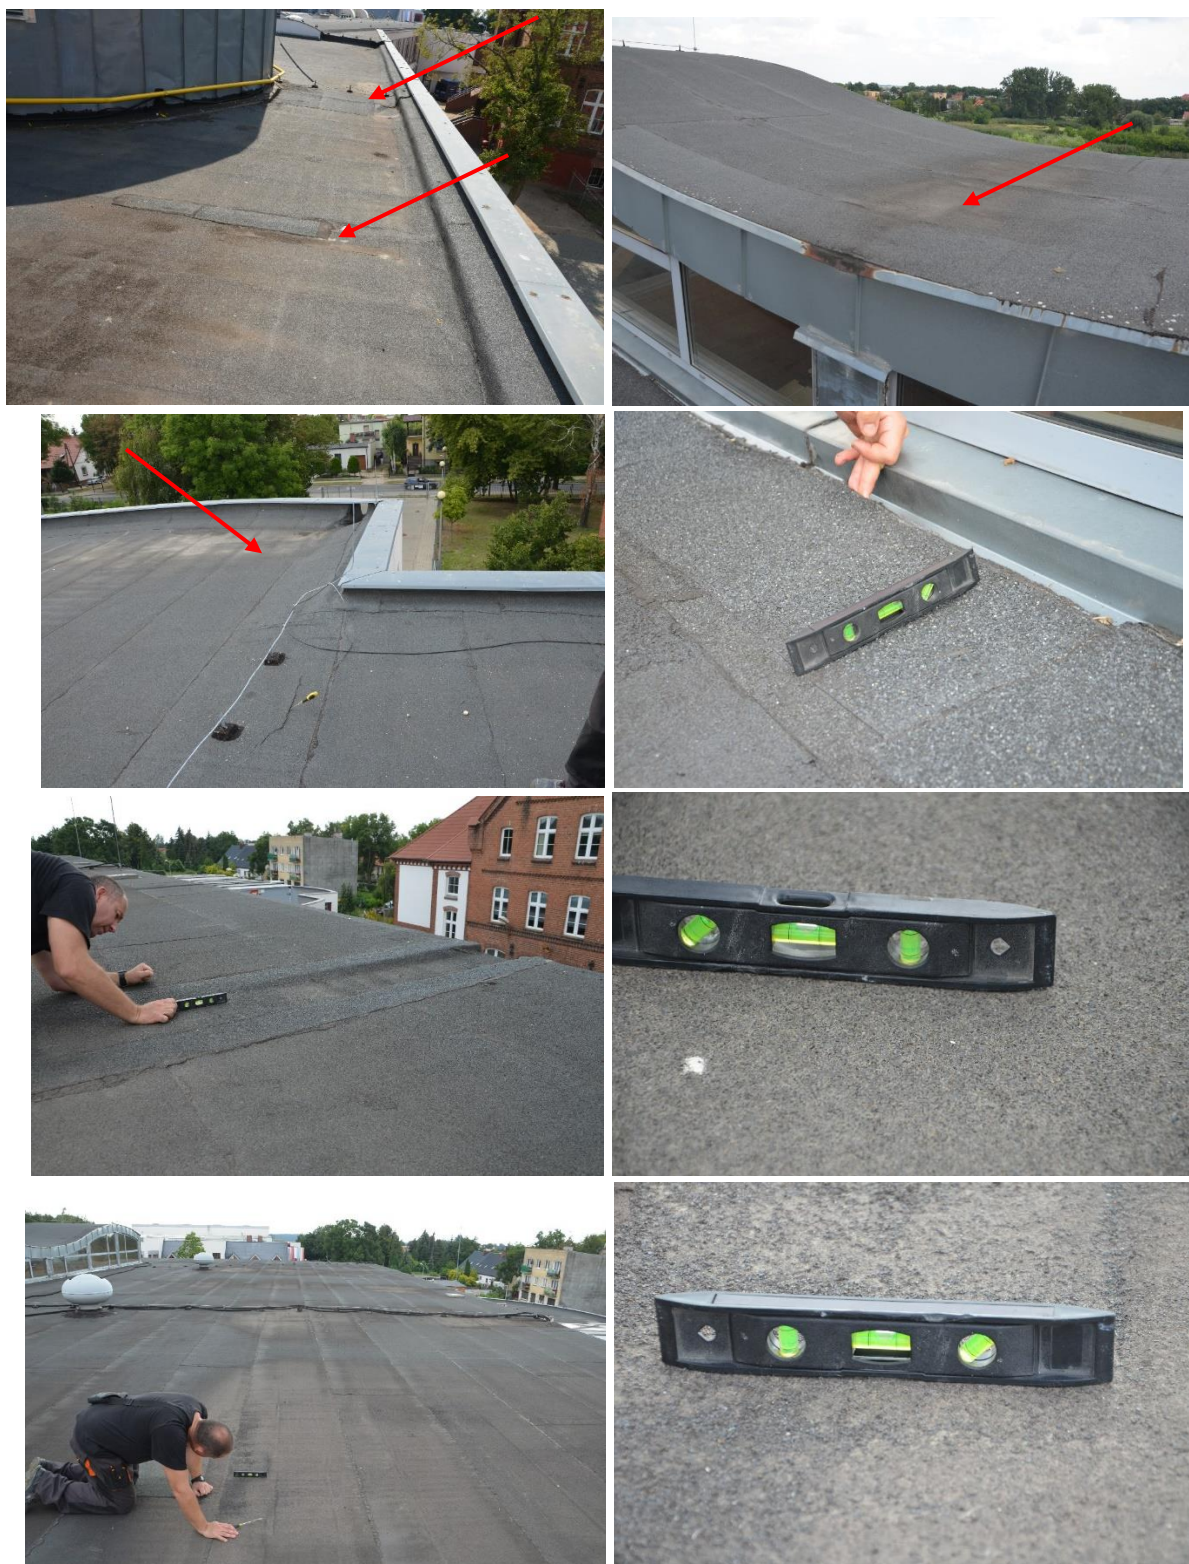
Brak szczelności w montażu opierzeni z elewacją ścian oraz attyką dachu.
